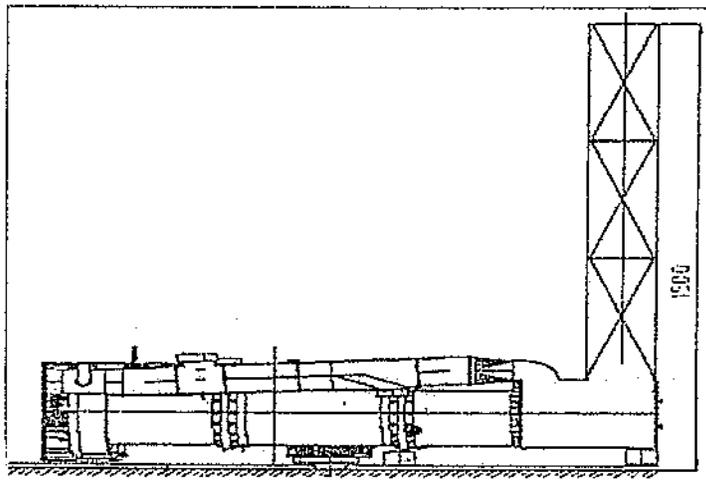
Esquema de la chimenea Planta OBRESCA S.A.
